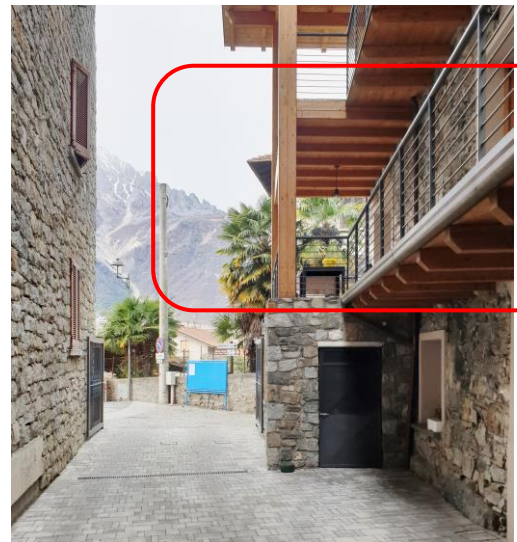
/23: vista del fabbricato dalla Via Breda, lato ovest e sud. Vista del terrazzo sud dal cortile interno.
